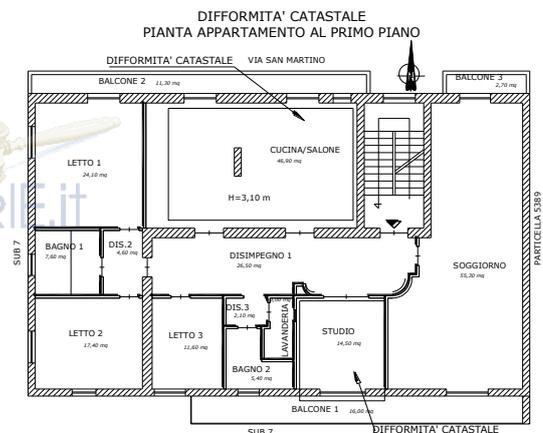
planimetria delle difformità catastali appartamento al primo piano
